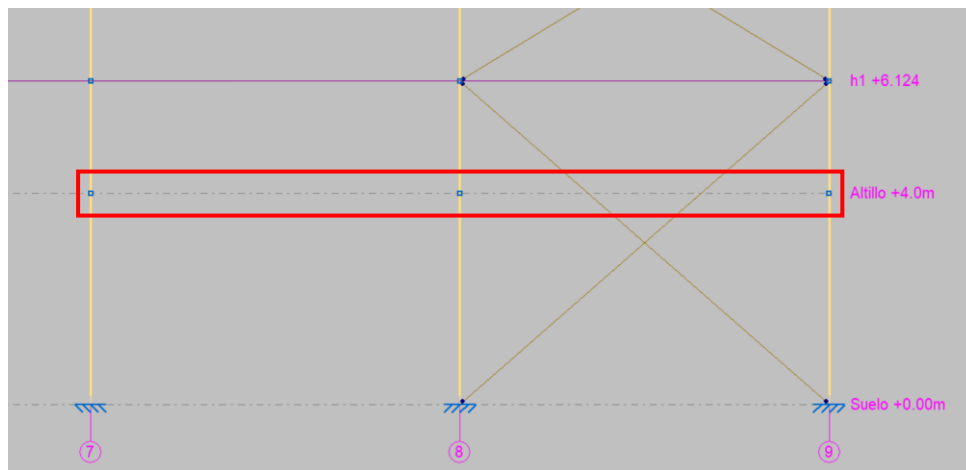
División de pilar en el pórtico de fachada. Fuente: CYPE 3D.
